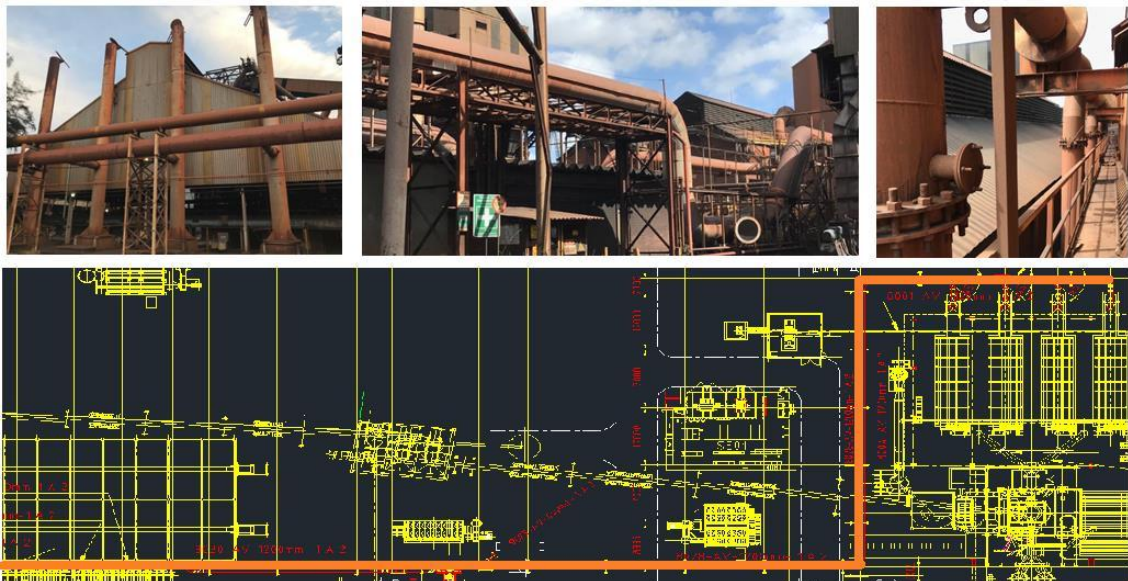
tubulação do sistema de secagem (fotos e desenho técnico)
